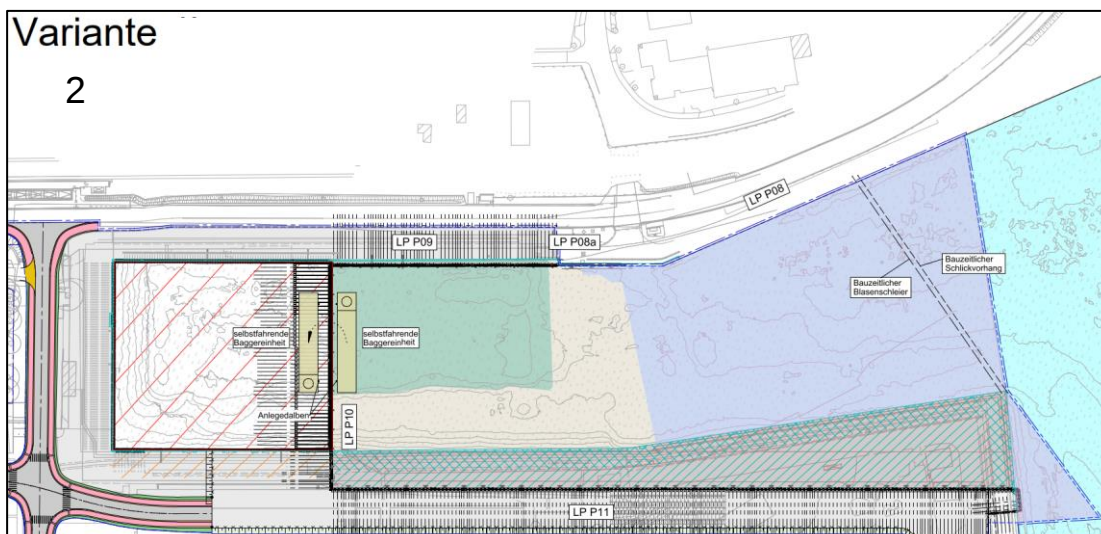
Prinzipdarstellung Variante 2: Baggerung und Verladung durch Baggereinheiten mit Laderaum
